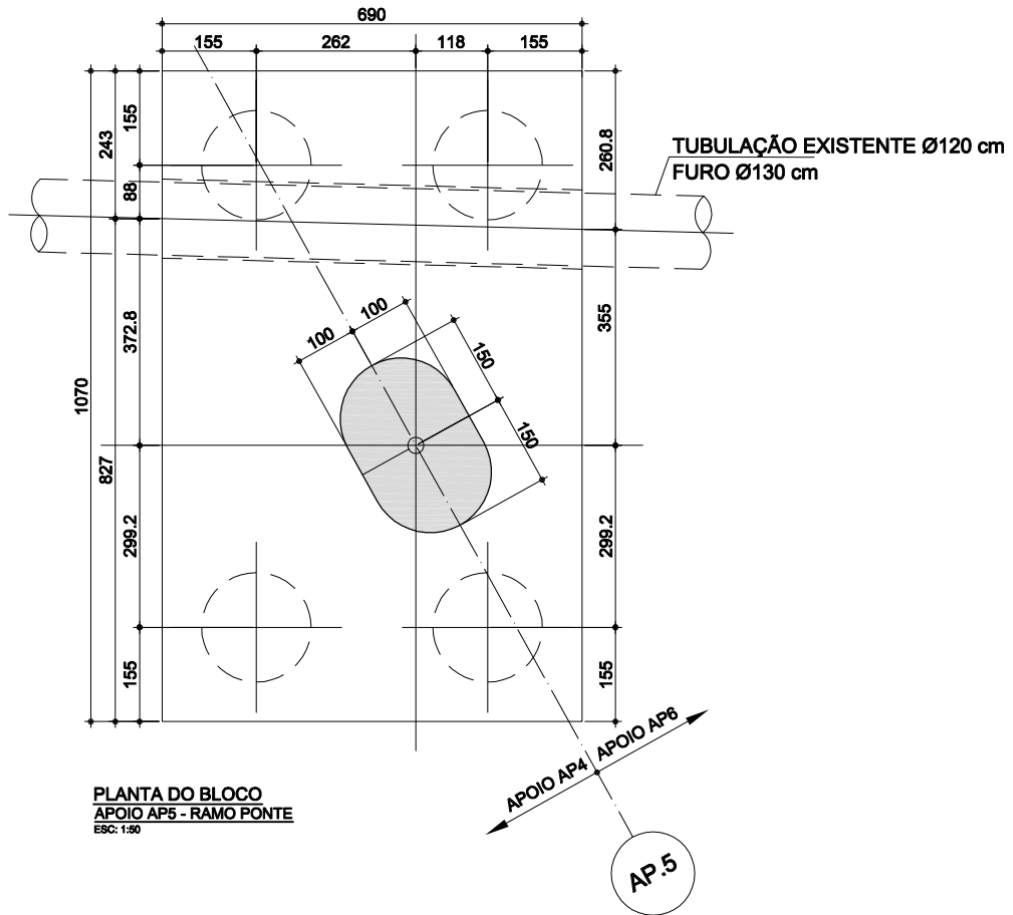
Tubulação passando pelo bloco AP5 - Planta
